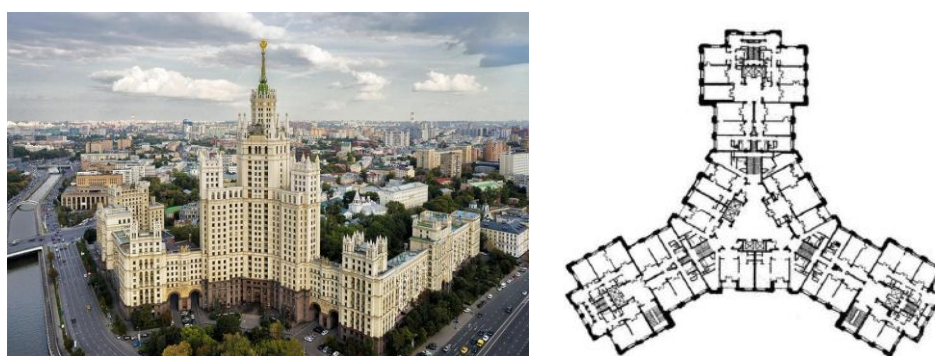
Жилой дом на Котельнической набережной в Москве, 1952 г. Общий вид, план типового этажа
